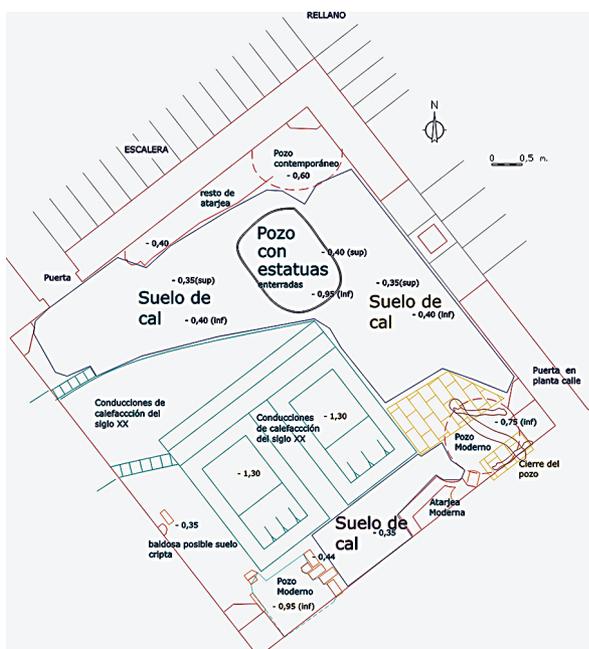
Planta de la excavación arqueológica en el subsuelo de la cripta.
